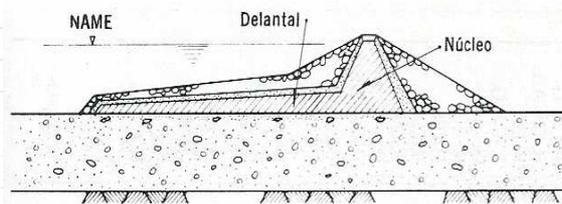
Presa con delantal impermeable ($H_c > 20$ m)
